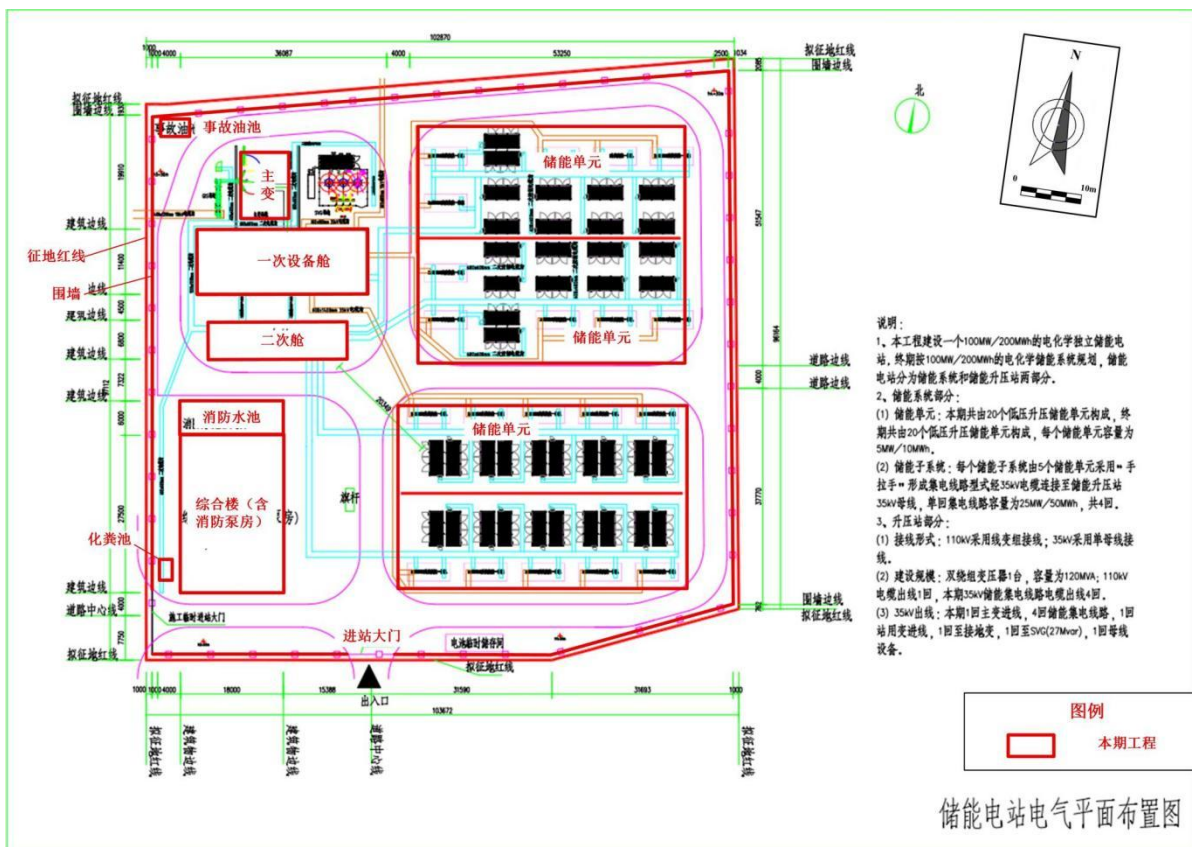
本项目储能电站（含 110kV 升压站）总平面布置图
